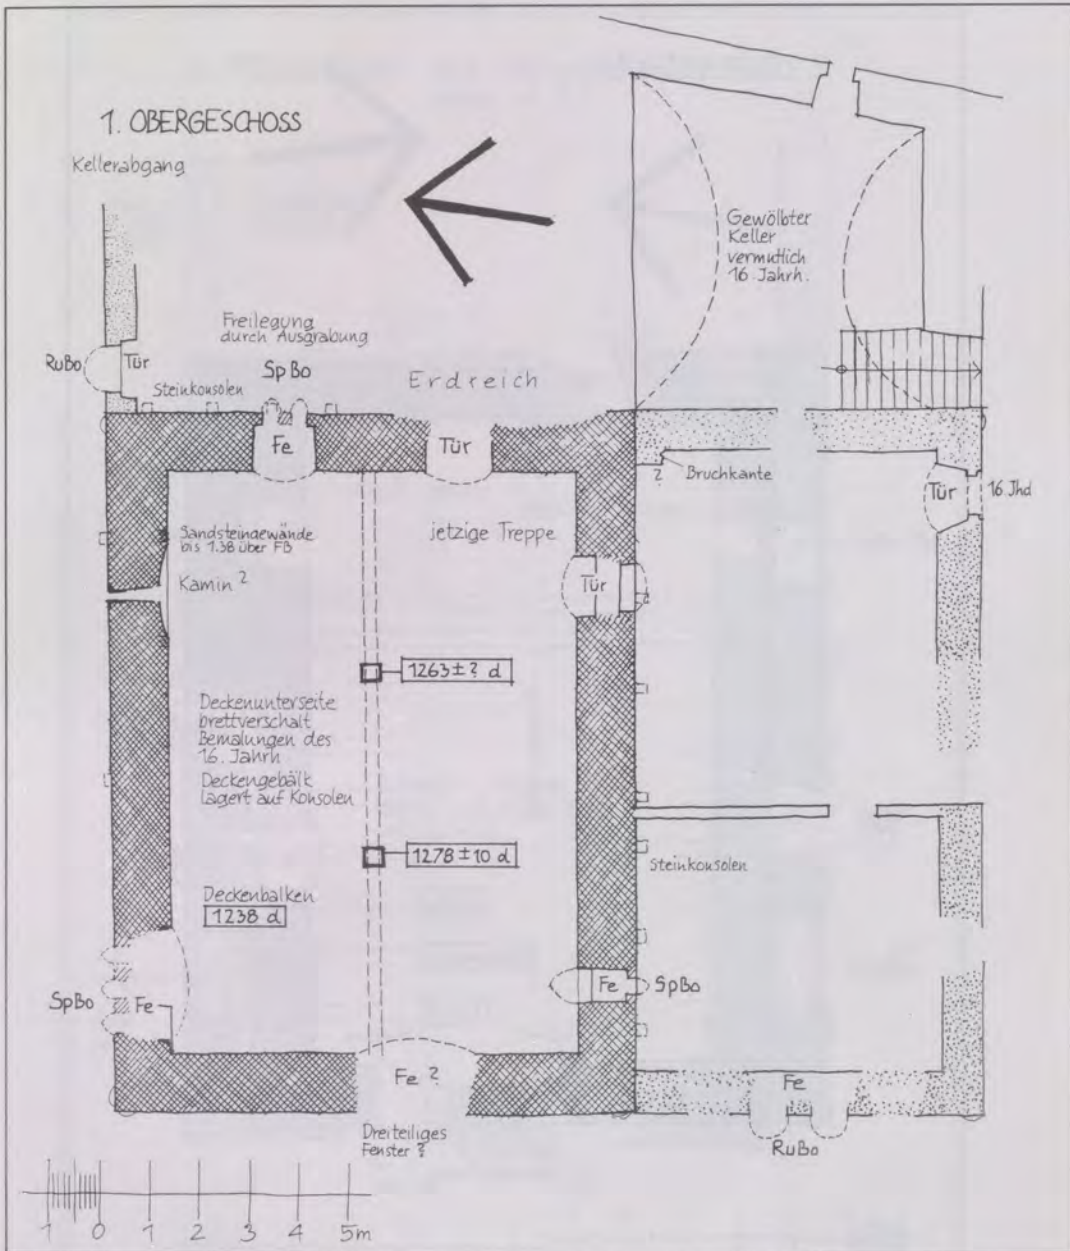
Grundriß 1. Obergeschoß. Legende siehe Erdgeschoß
